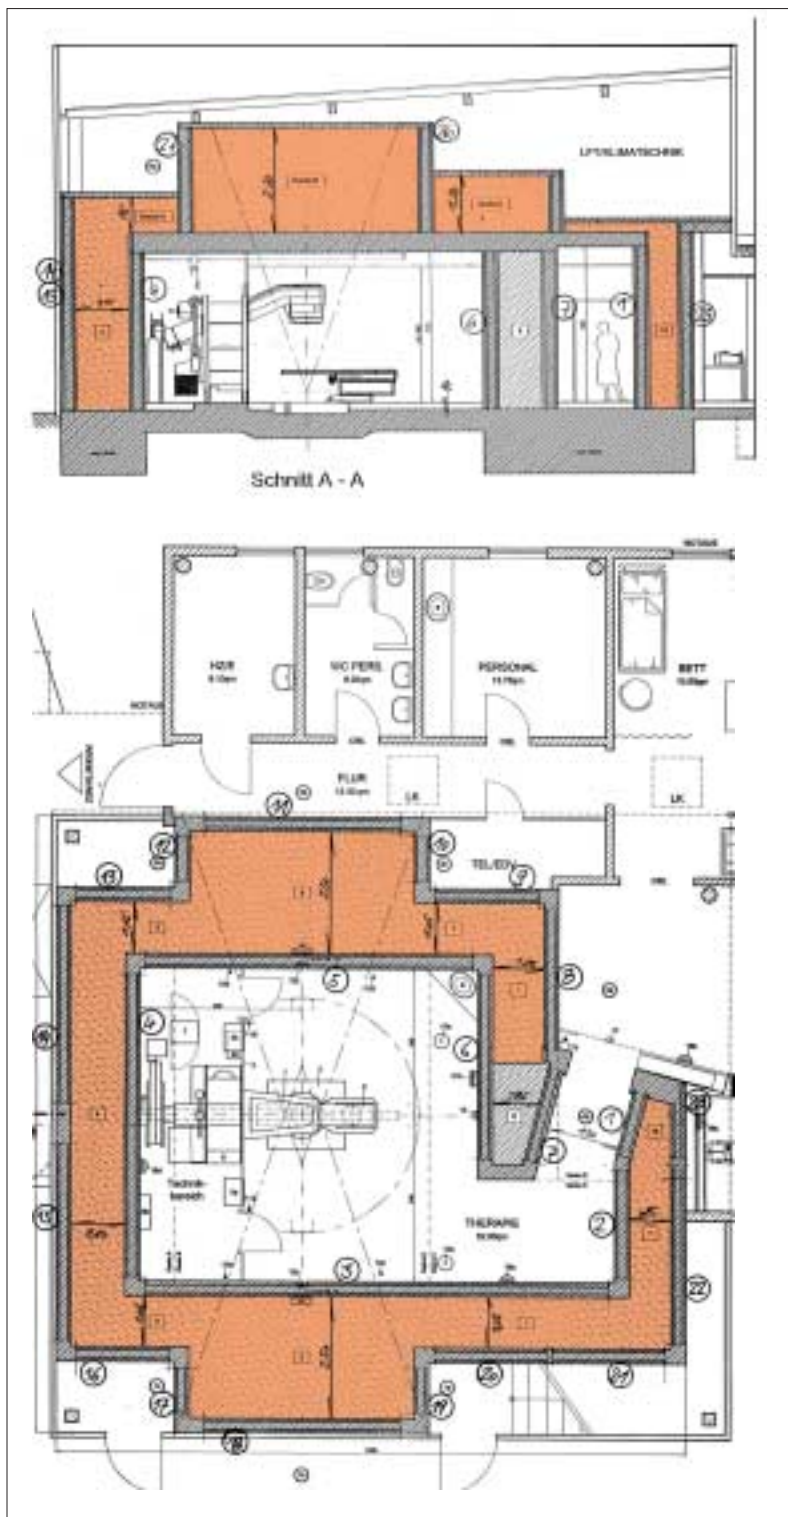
Alzado y planta de la sala de radiación. Es fácil apreciar cómo las paredes de hasta 3,10 m de espesor se sustituyen por dos carcassas externas de 30 cm de espesor empleando paneles de doble pared entre los que se aporta un relleno mineral. (Planos sin escala)
